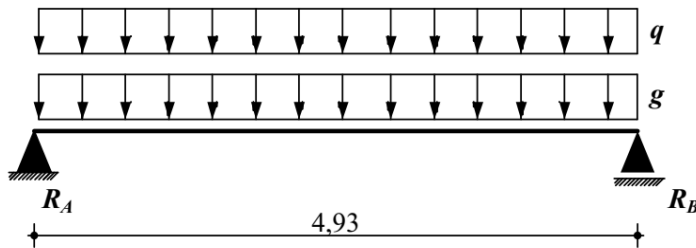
Sistema estático de lajes aligeiradas, considerado secção efectiva em viga T de largura útil $b = 0.51 \text{ m}$
